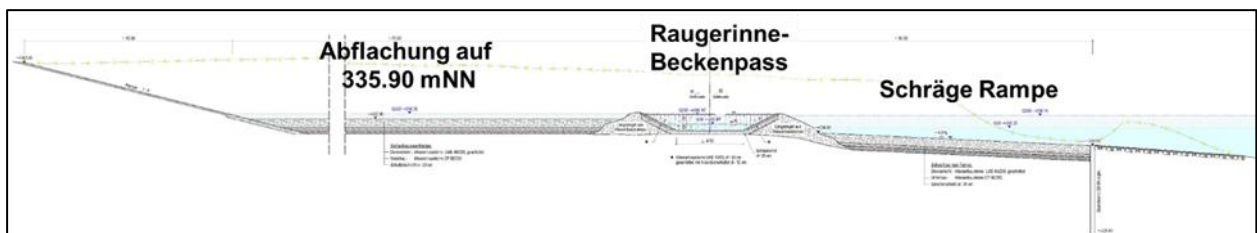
Sohlaufbau raue Rampe [3]
